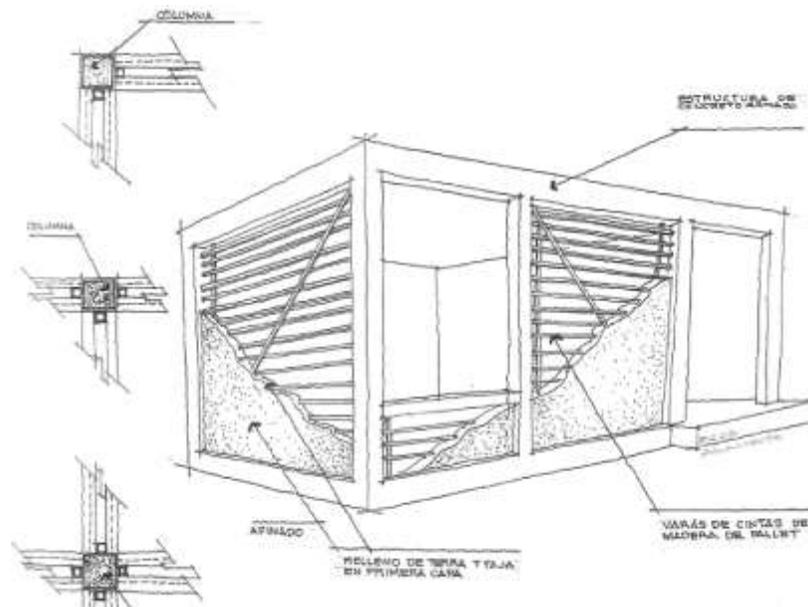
Estructura de sistema constructivo bahareque-marcos rígidos de concreto armado
